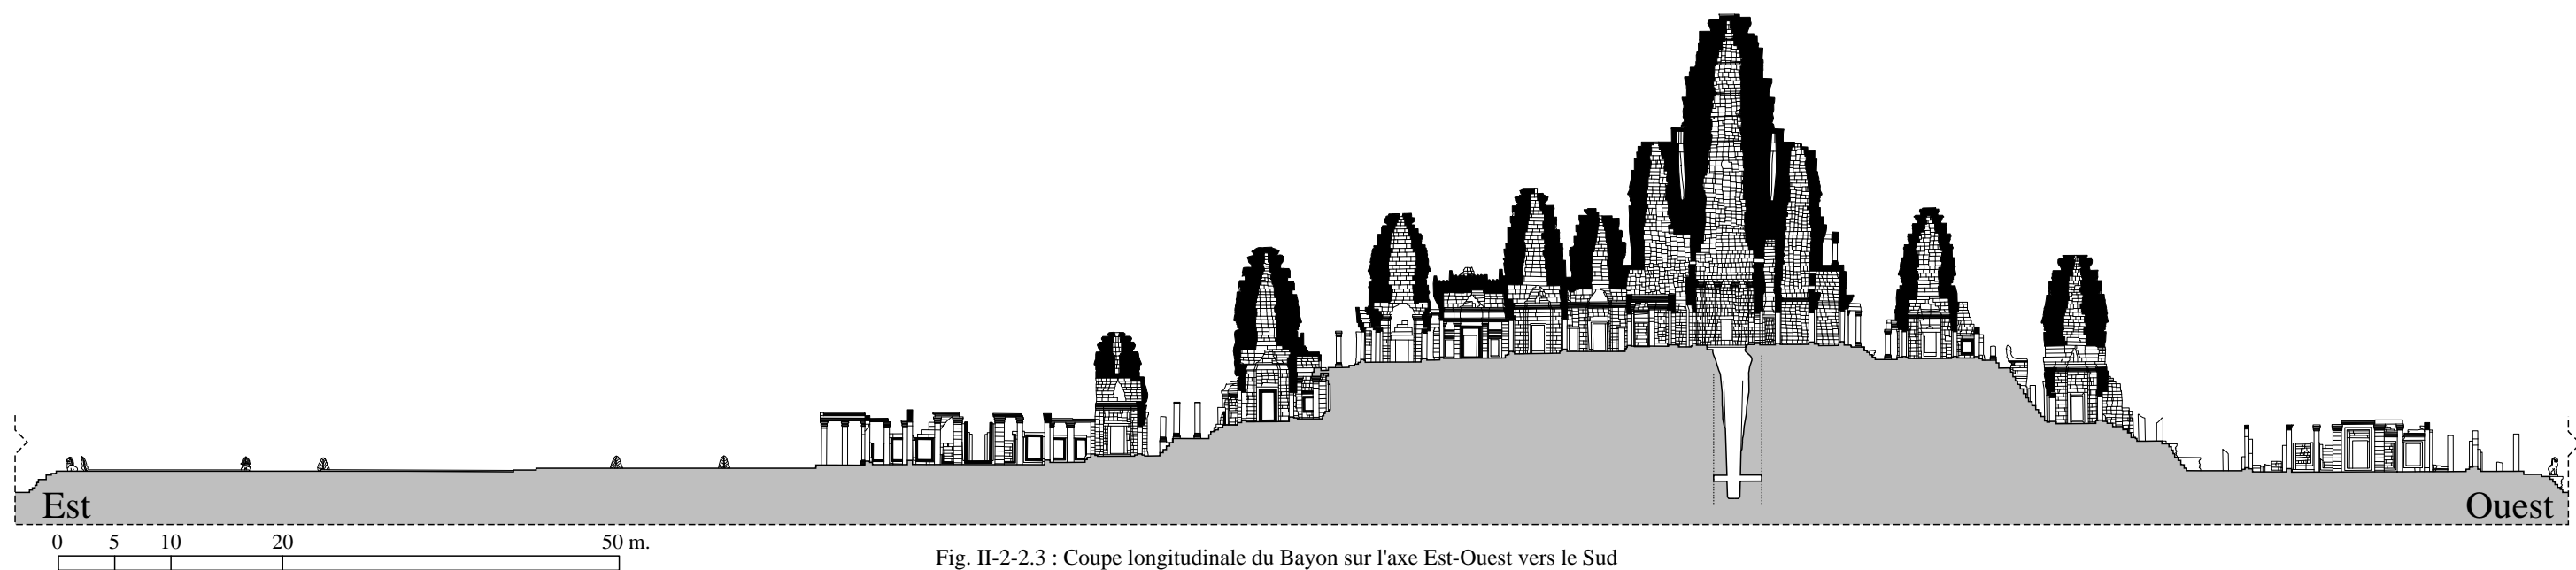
Coupe longitudinale du Bayon sur l'axe Est-Ouest vers le Sud
